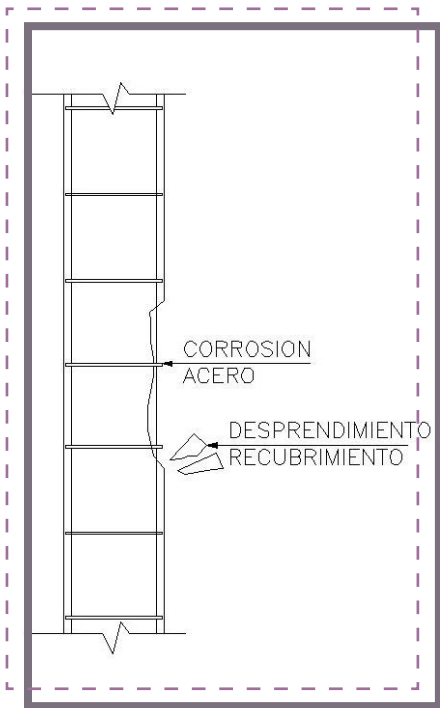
Esquema de la corrosión en la armadura de un pilar de hormigón armado.
